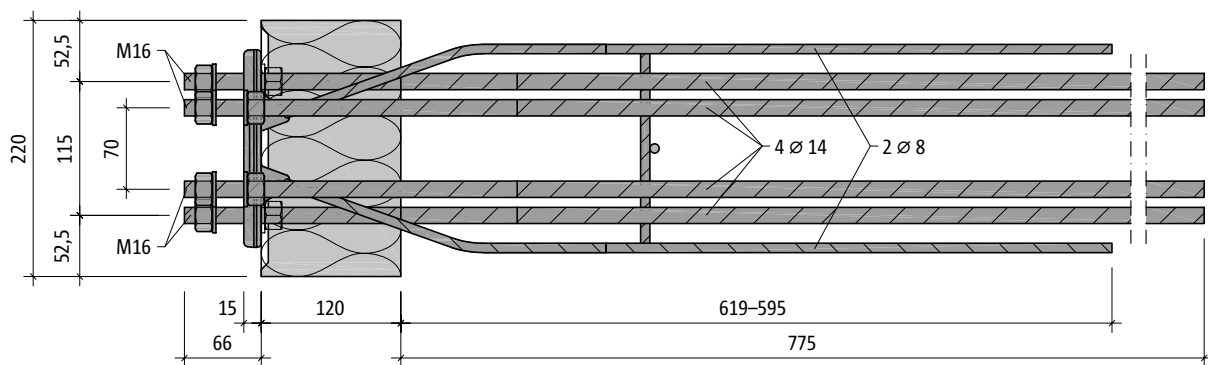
Schöck Isokorb® XT Typ SK-MM1-VV1: Grundriss
